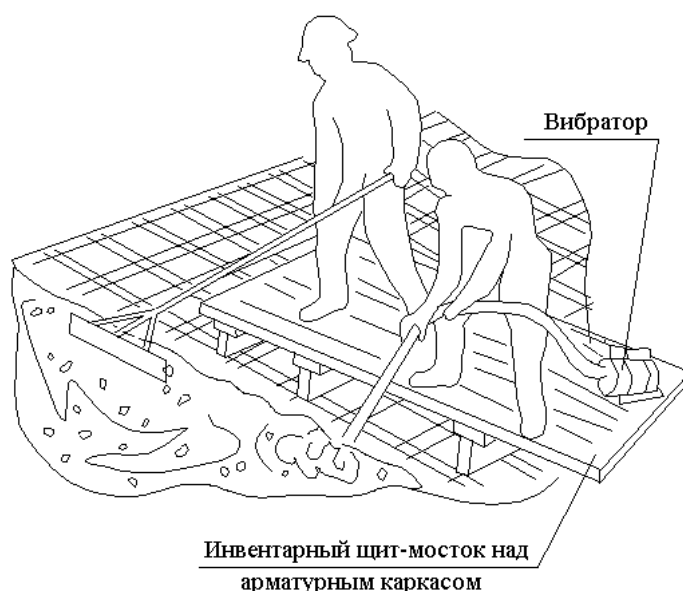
Схема организации рабочего места при уплотнении бетона
